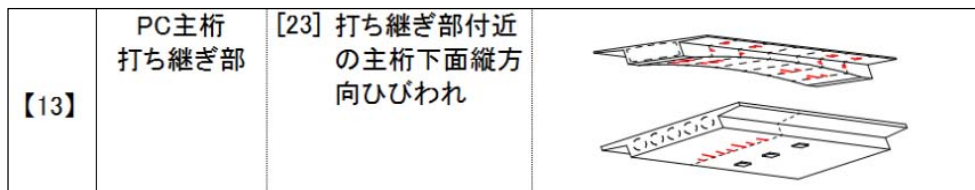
ひび割れパターン13（分割施工における新旧打継ぎ目に発生するひび割れ）
